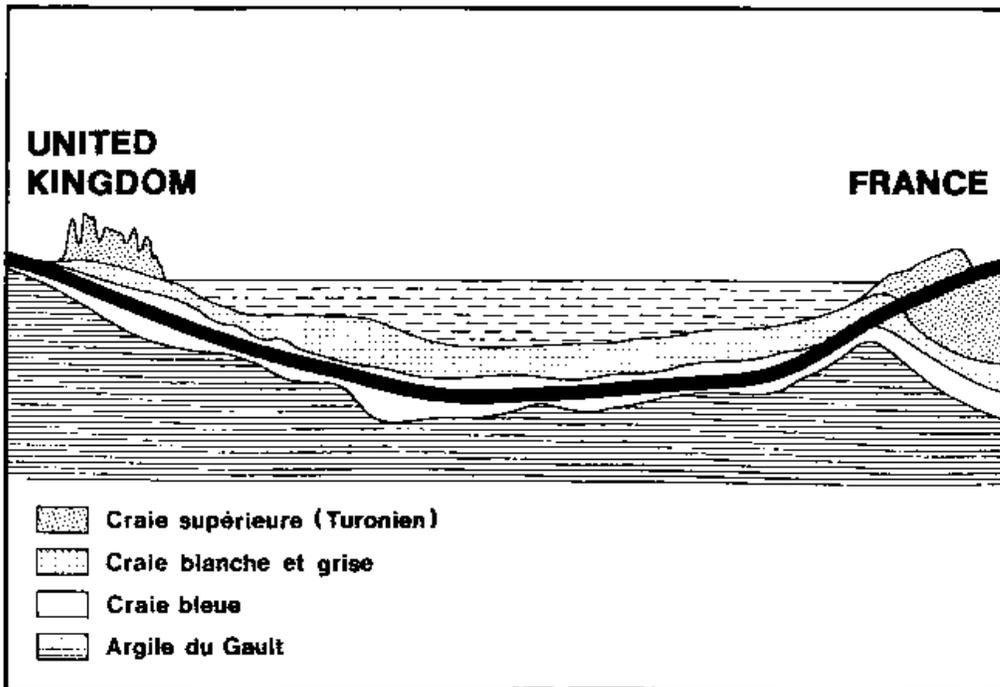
PROFIL EN LONG DU TUNNEL SOUS LA MANCHE
